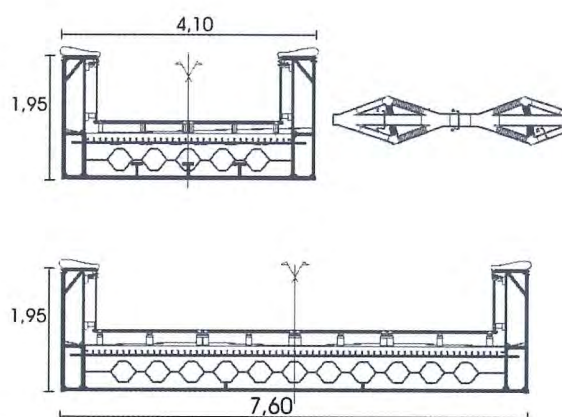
Coupes à mi-travée et rampes / Mid span and side ramps cross sections
